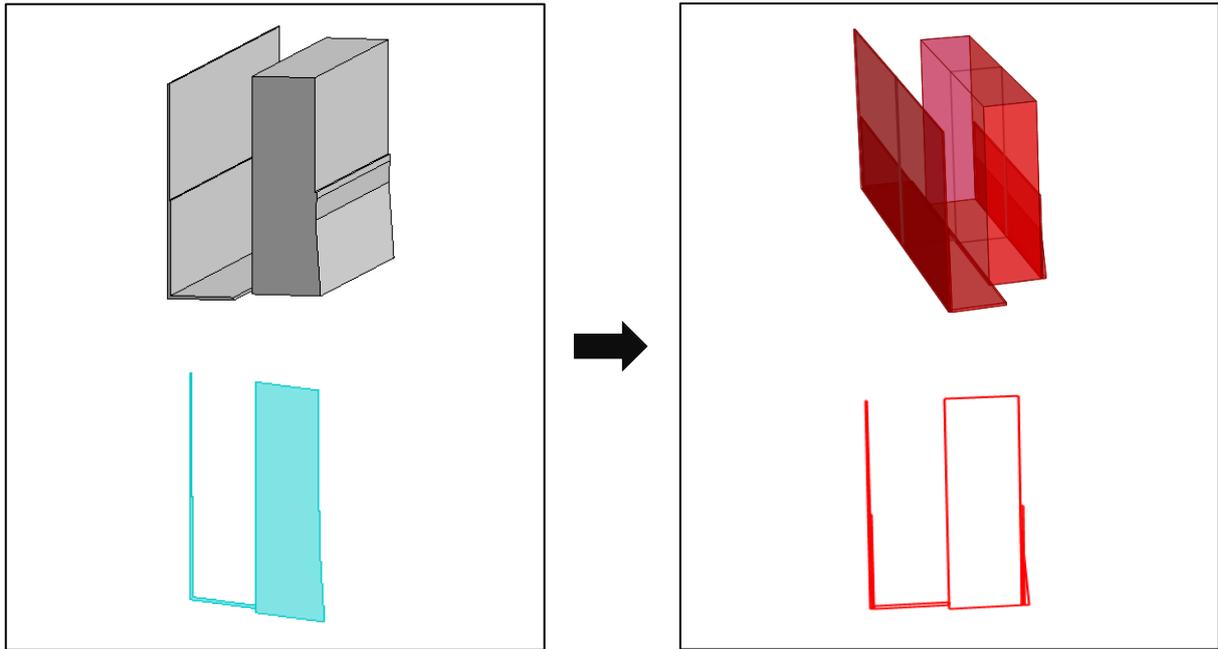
Export spalla - Famiglia: Muro strutturale
